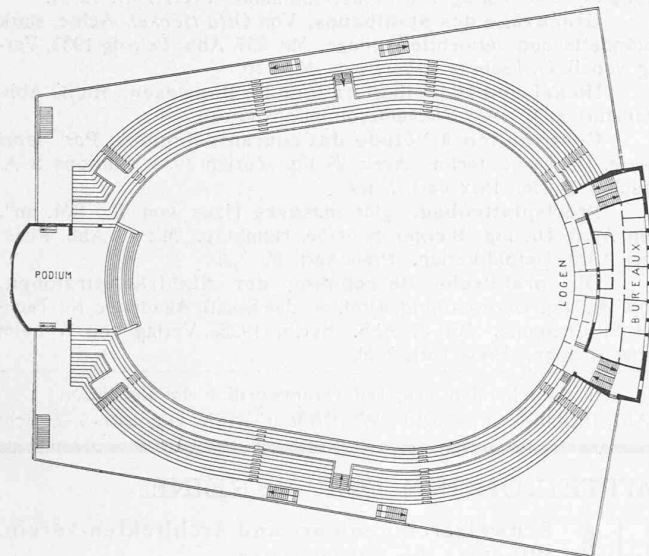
Grundriss der Tribünen. — Masstab 1 : 1200.
